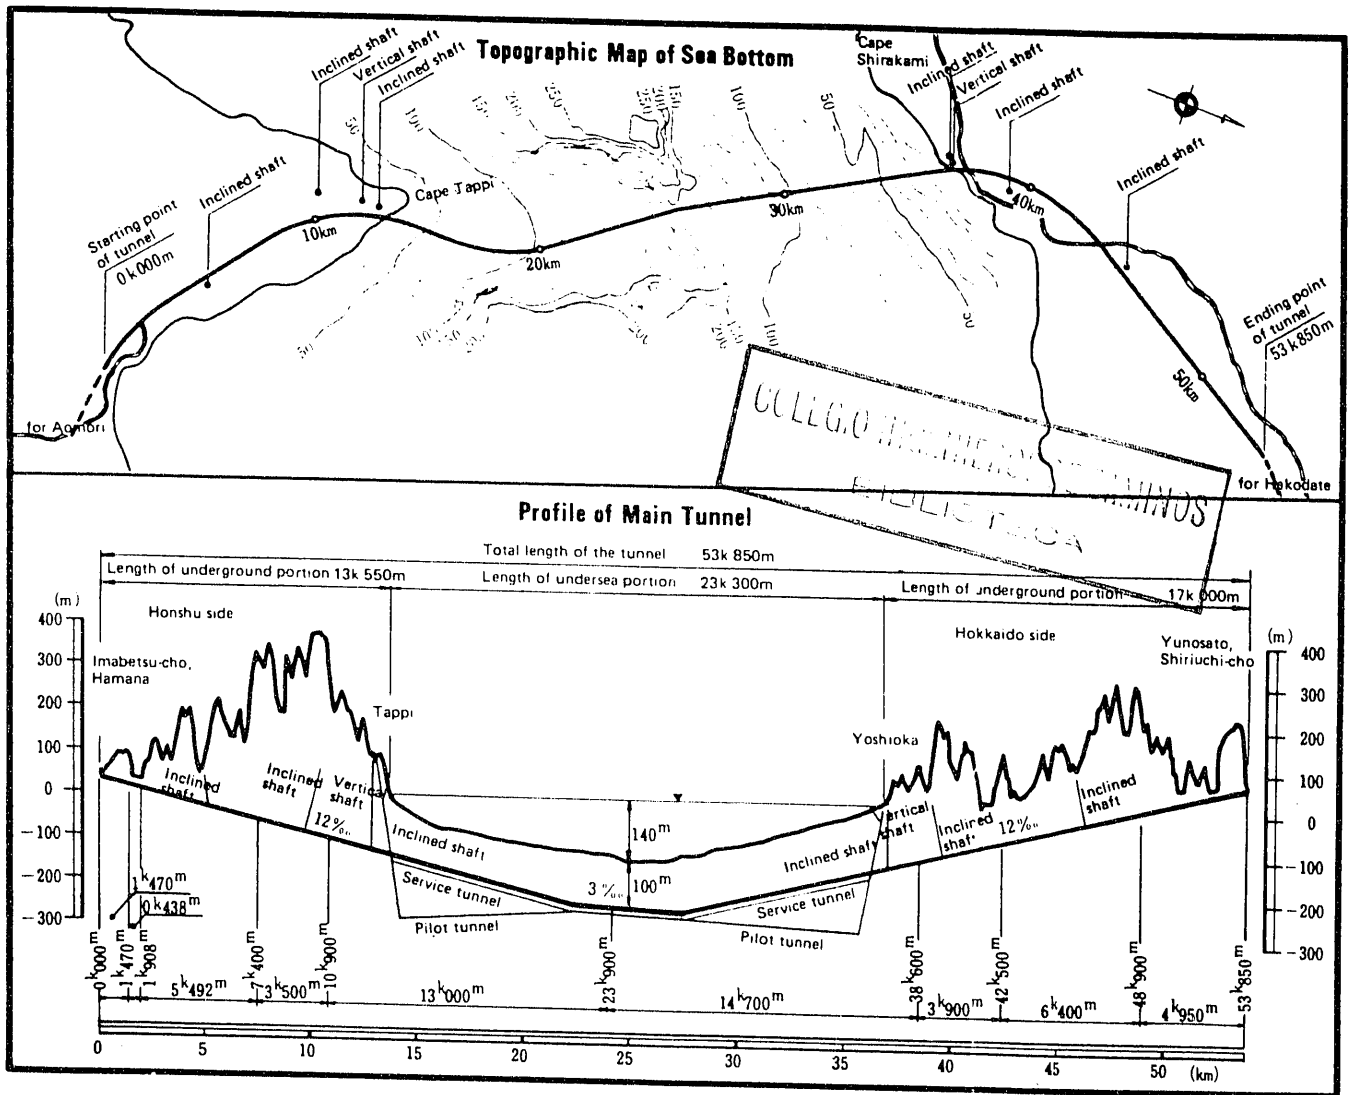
Planta y perfil longitudinal del túnel de Seikan.
